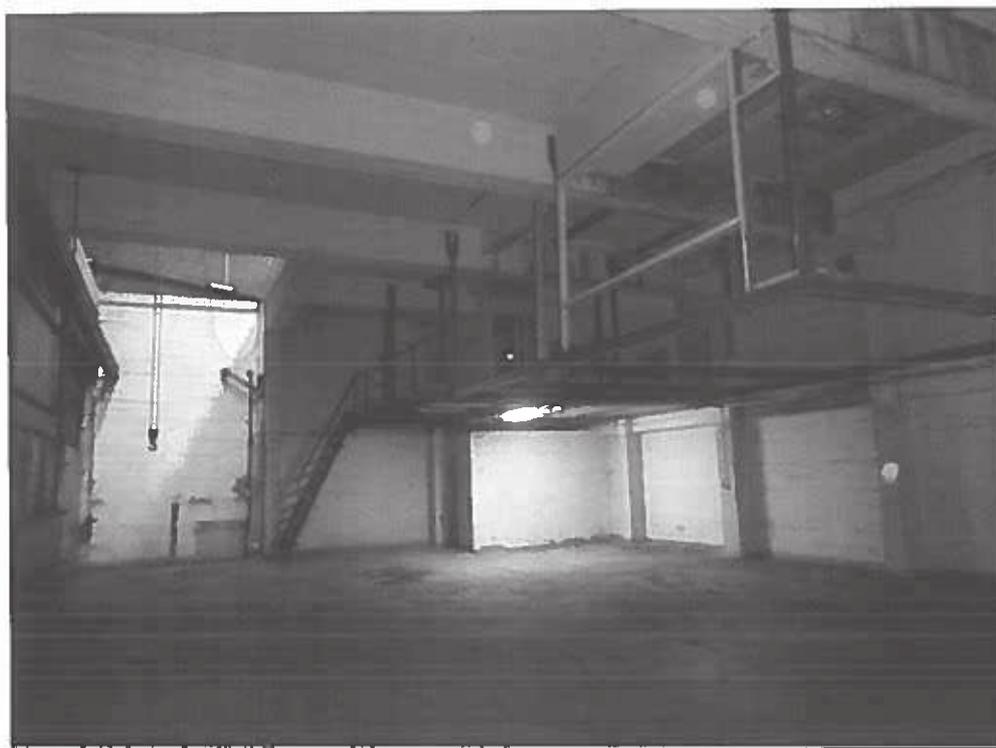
Vue générale du RDC avec mezzanine suspendue
